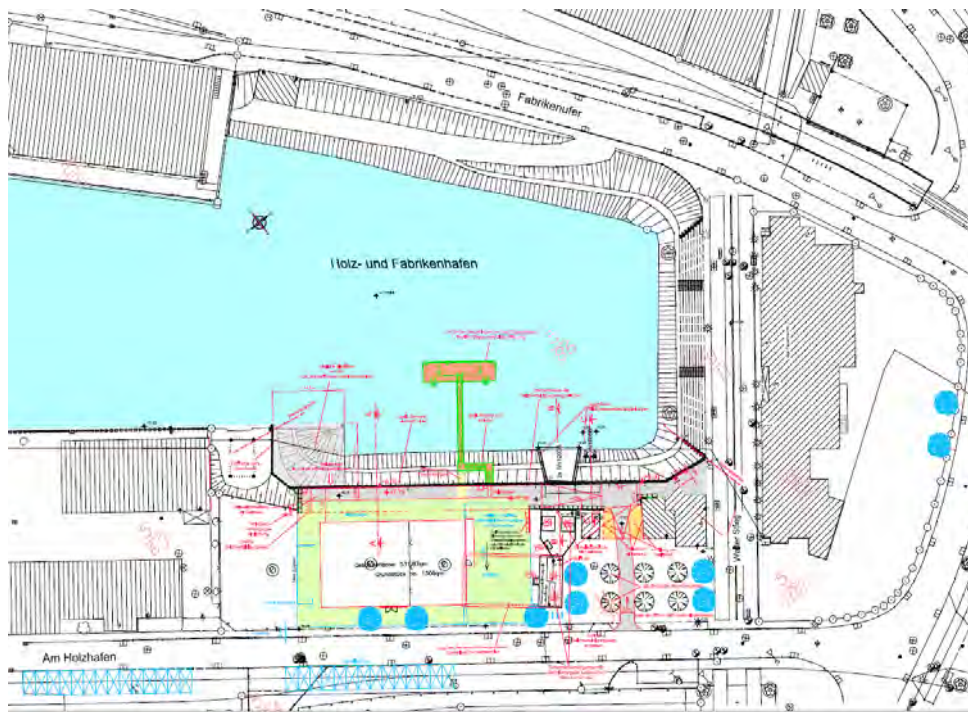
Lageplan Umgestaltung Hochwasserschutz Kopf Holz- und Fabrikenhafen.
